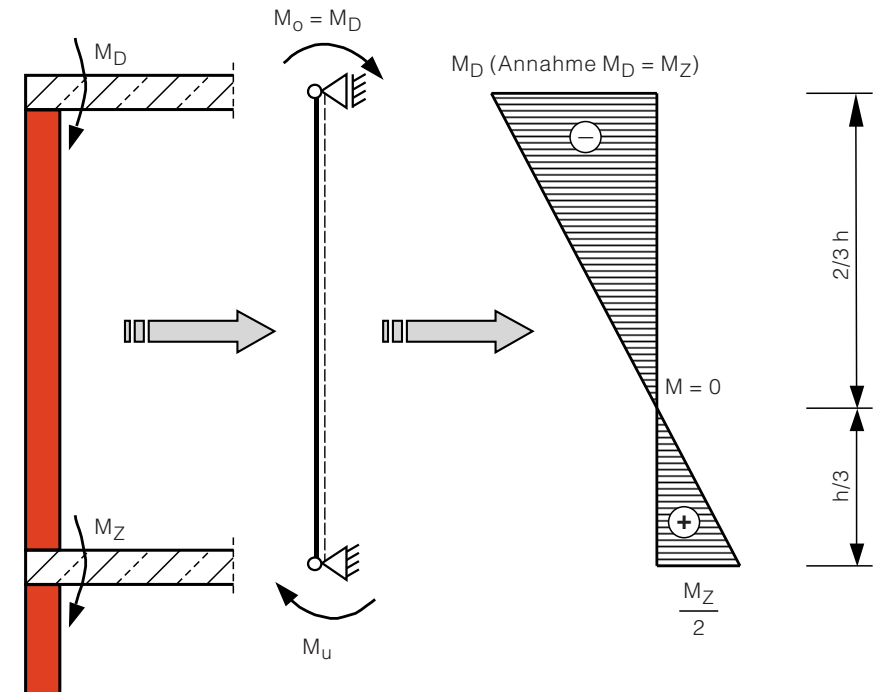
Querschnitt - statisches System - Momentenverlauf in einer Außenwand im Dachgeschoss
